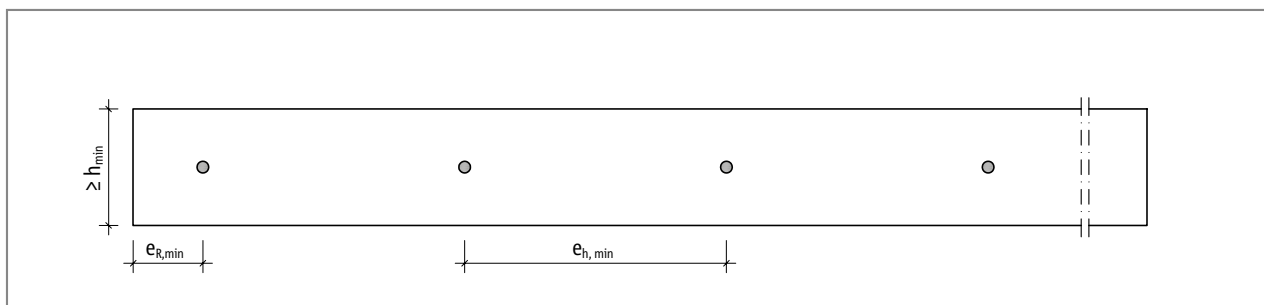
Schöck Dorn type LD : Dimensions minimales de l'élément de construction et distances entre les goujons pour une dalle
